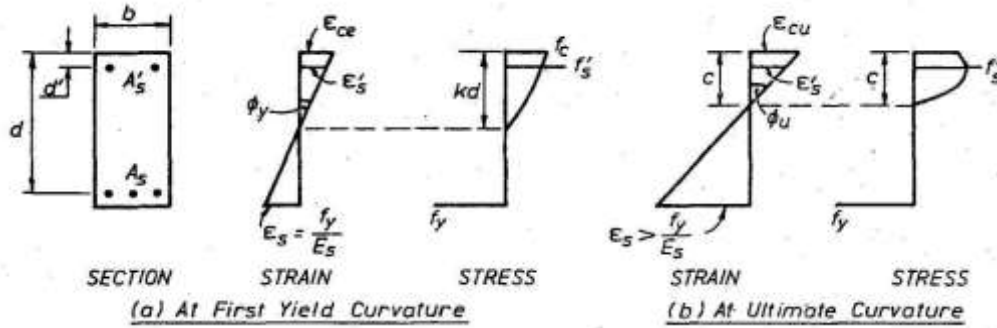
Sección de viga doble refuerzo en concreto no confinado sometida a Flexión, ref[10] pp 218
